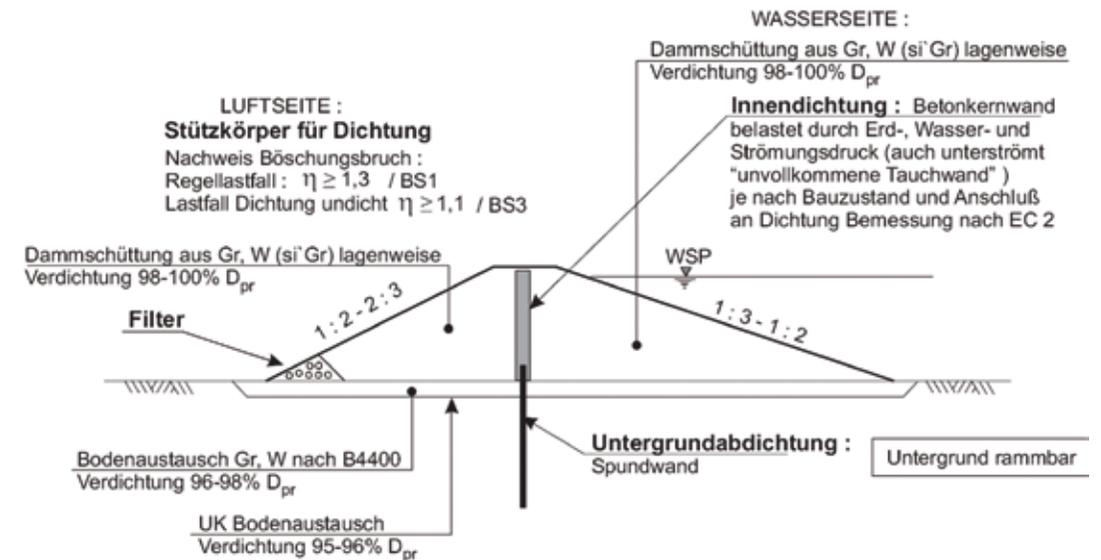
Bautyp – Damm mit Betonkern und Untergrundabdichtung Spundwand
